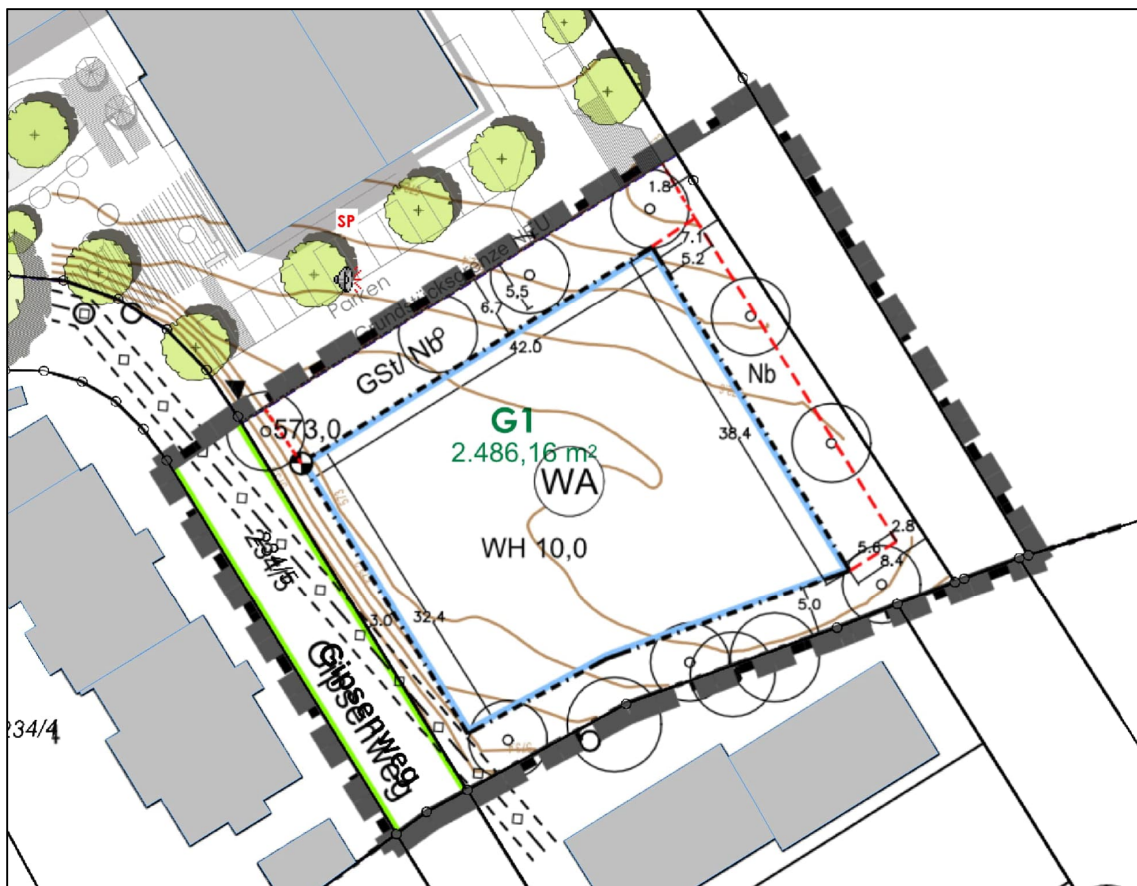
Lageplan mit Darstellung der Punktschallquelle (SP)
